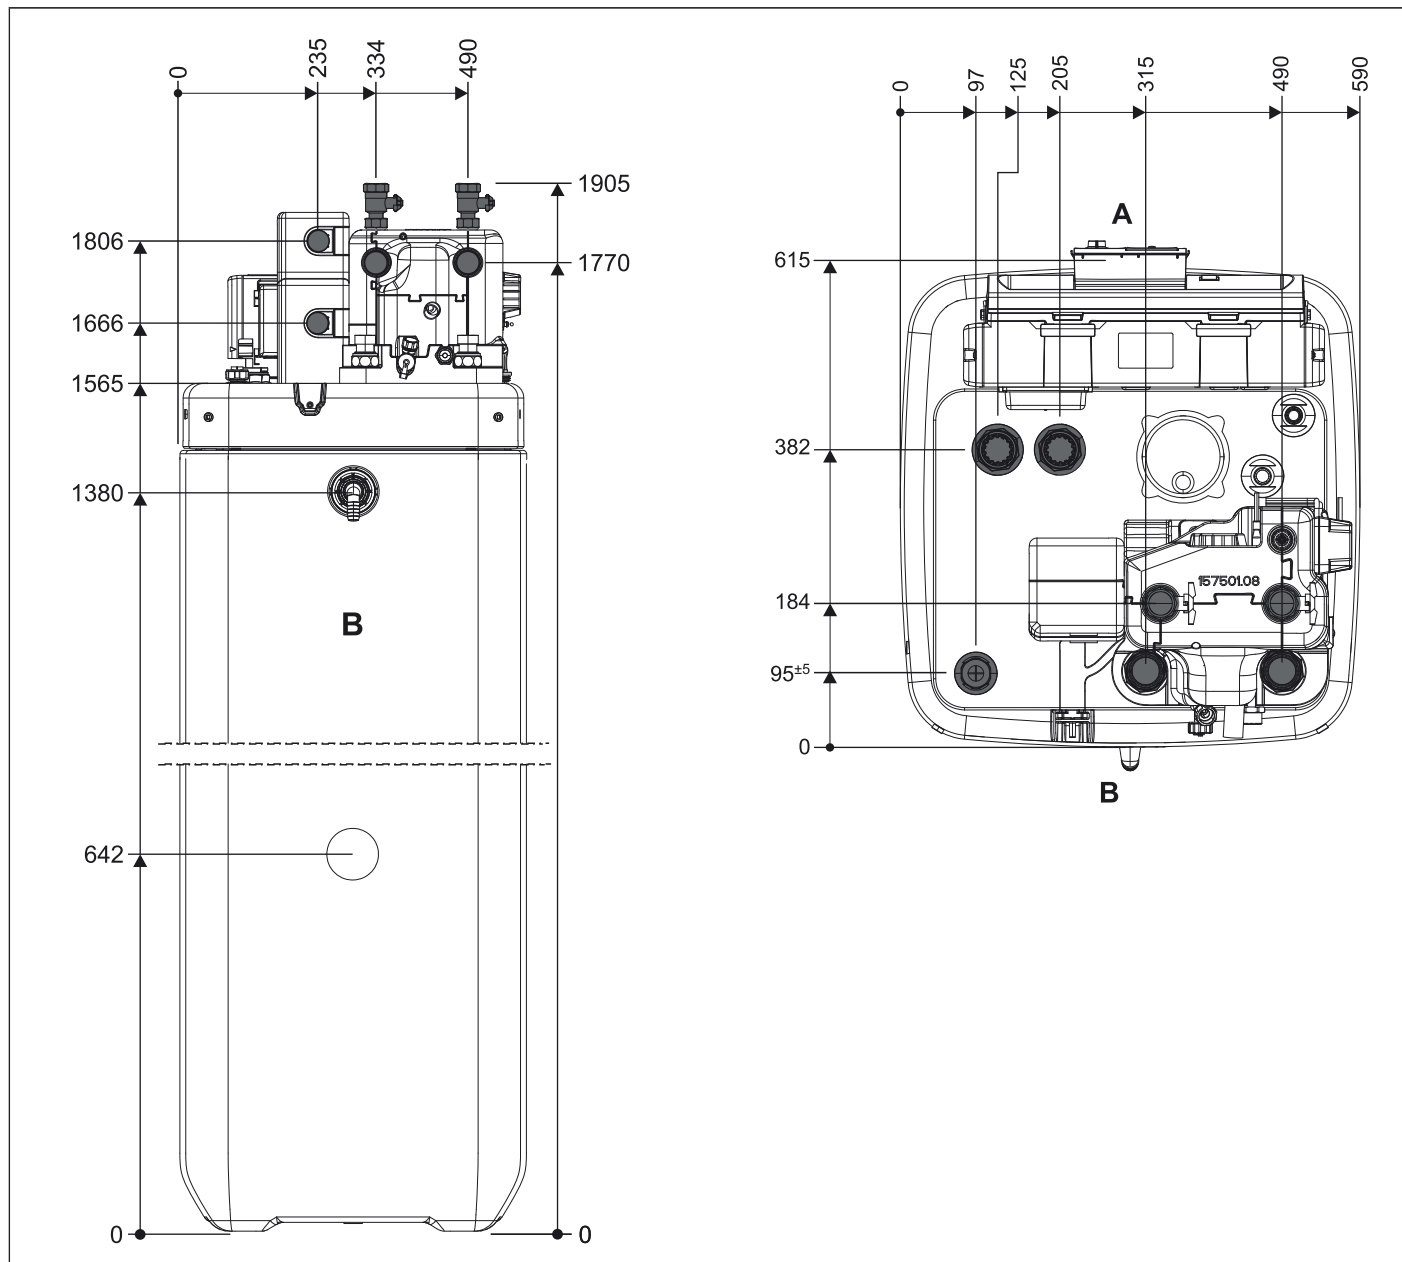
Anschlüsse und Abmessungen RKHWMX(B)300C
